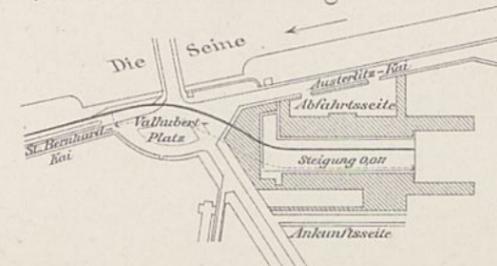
Grundriss des Vallubert-Bahnhofs.
